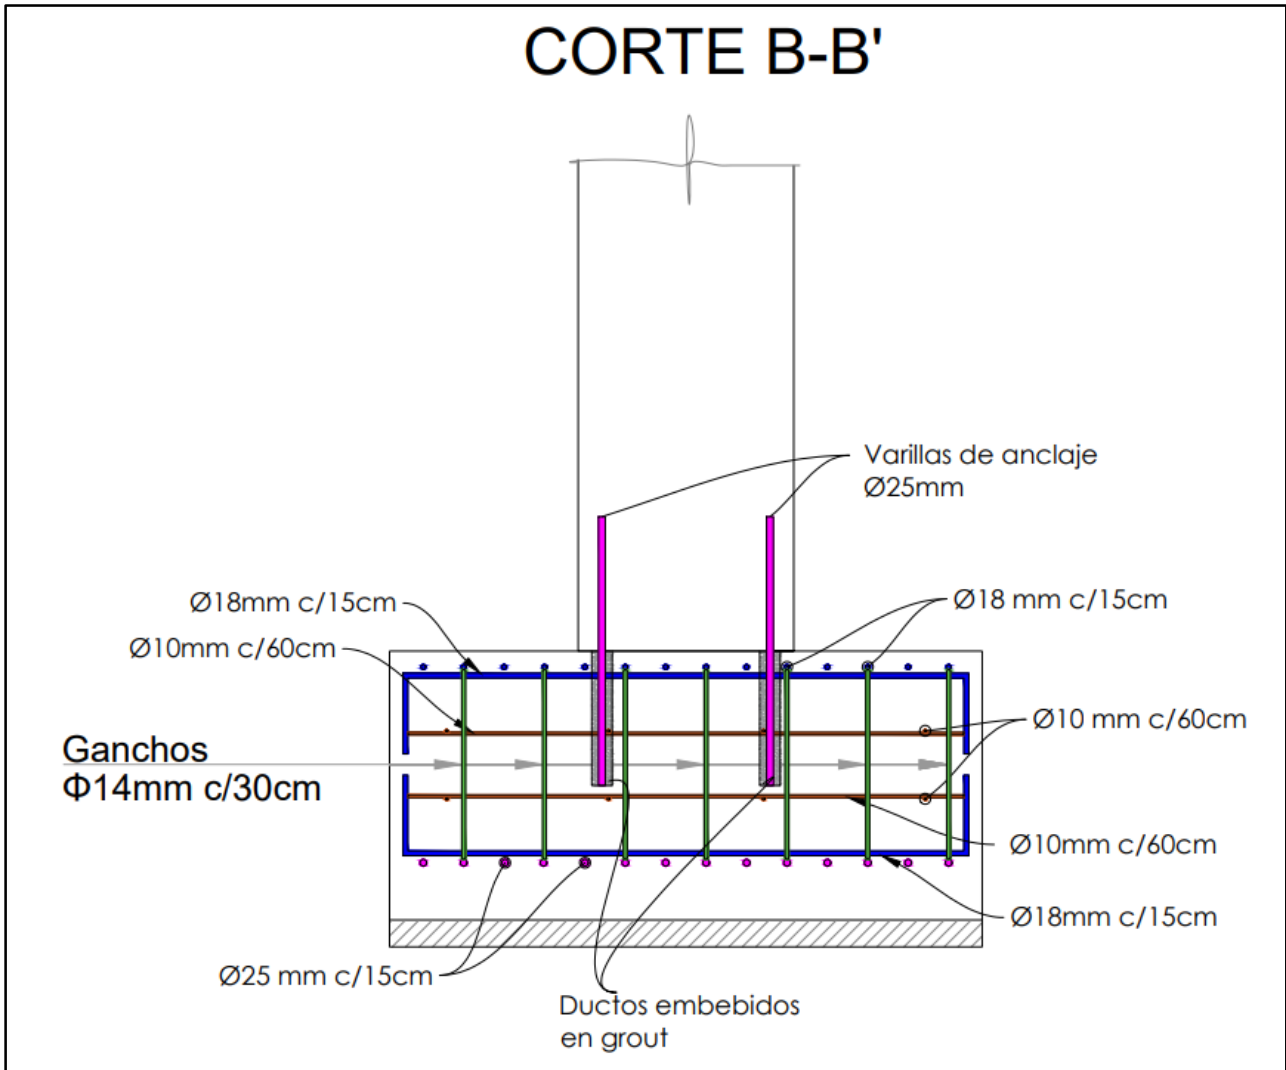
Armado de la zapata en el corte B-B'. Fuente del autor.
